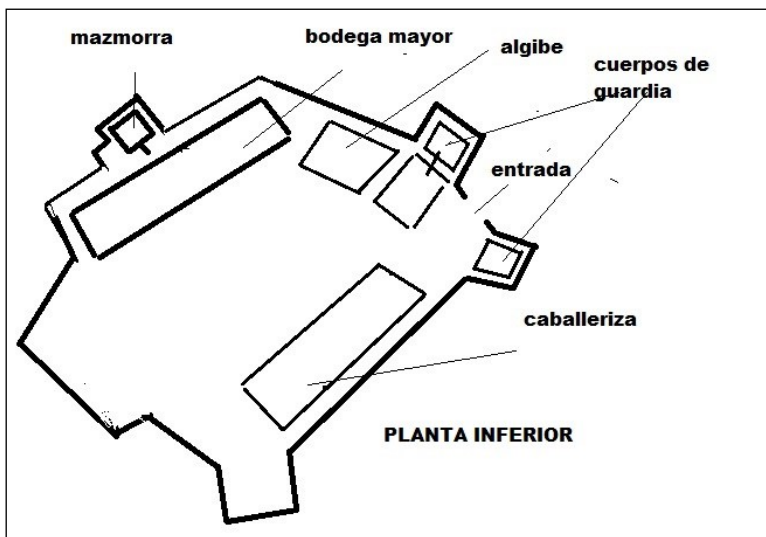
Croquis de la planta inferior (F.J. Soriano)
